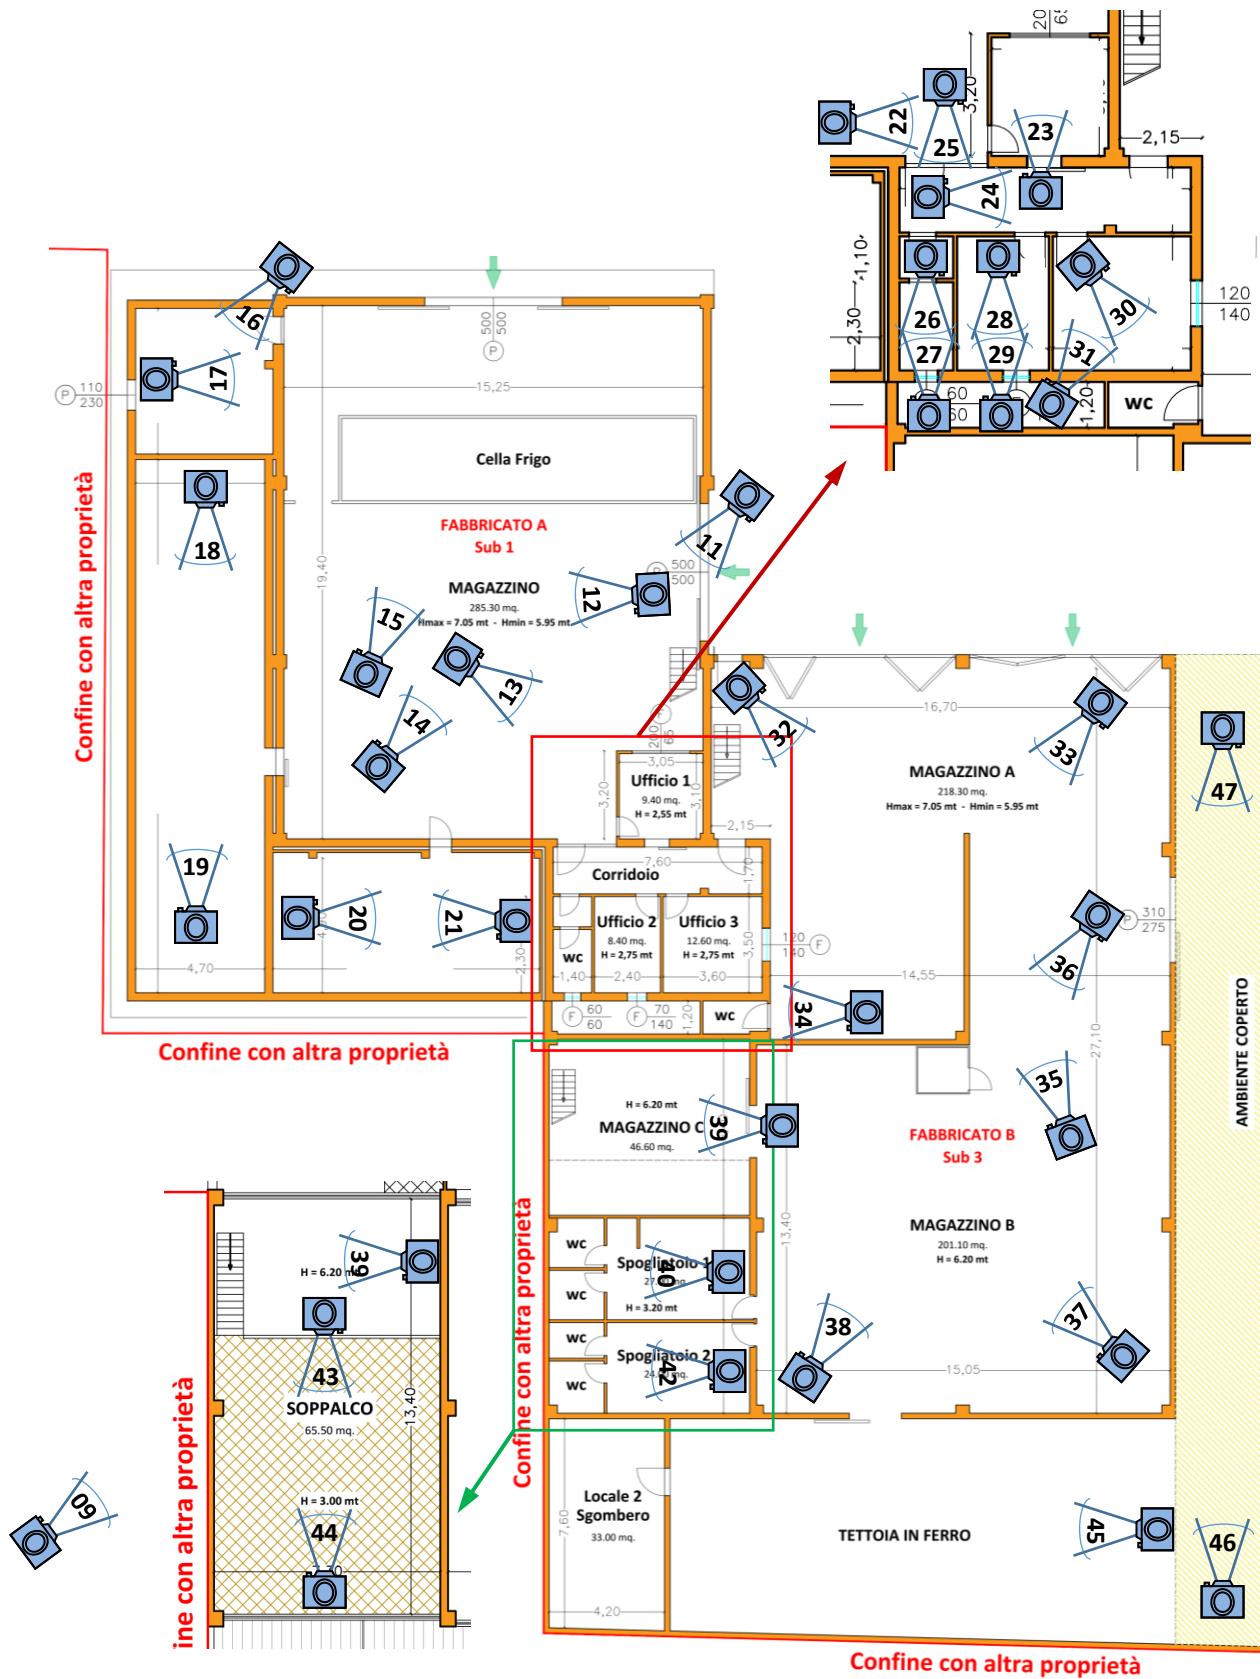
Planimetria con indicate la posizione e l'angolazione delle foto.
